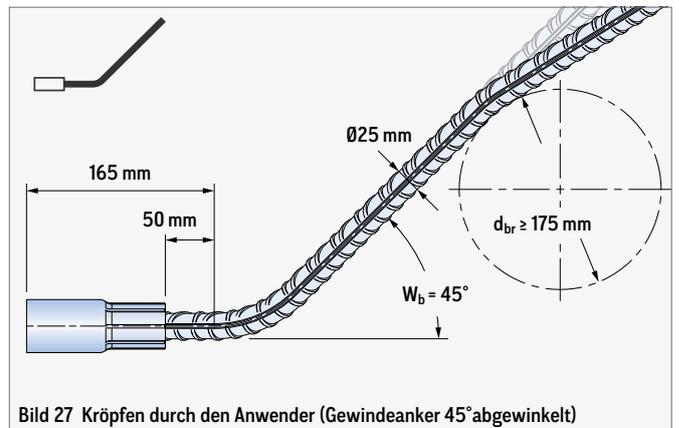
Kröpfen durch den Anwender (Gewindeanker 45° abgewinkelt)
